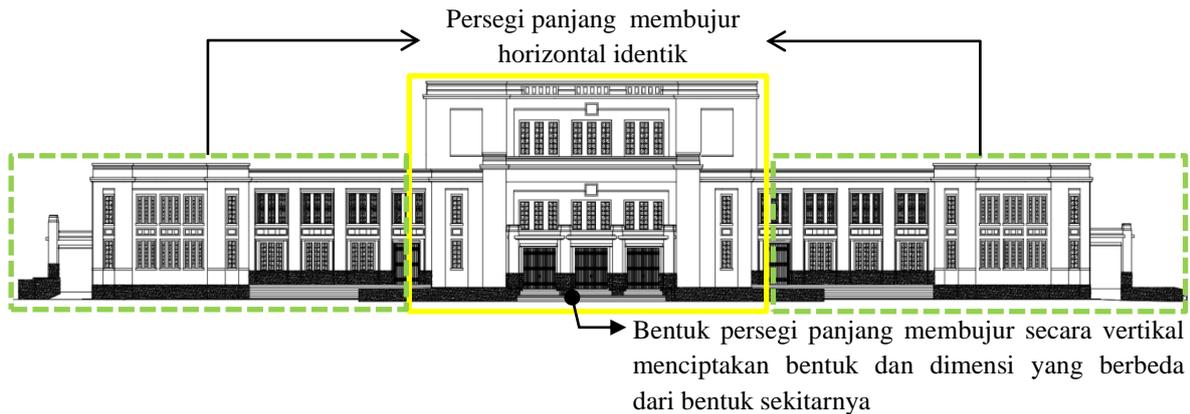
128 Proporsi Bangunan Berdasarkan Tinggi dan Lebar Tampak Samping
